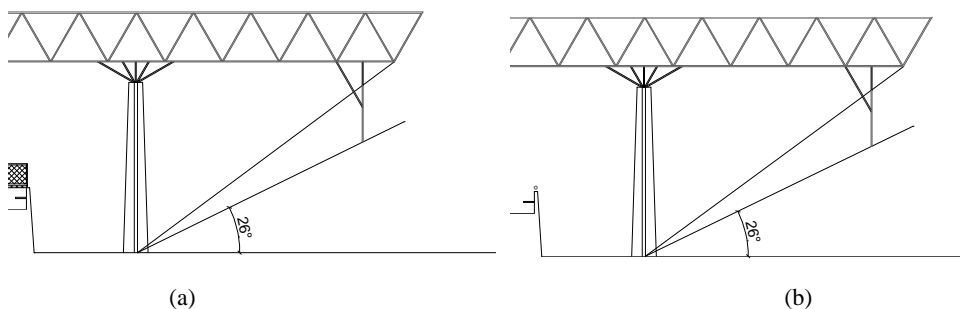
Corte esquemático da (a) Fachada Nordeste e da (b) Fachada Sudeste apresentando o ângulo de proteção solar proporcionado a partir da inserção dos protetores verticais e beiral na edificação em estudo – sem escala
